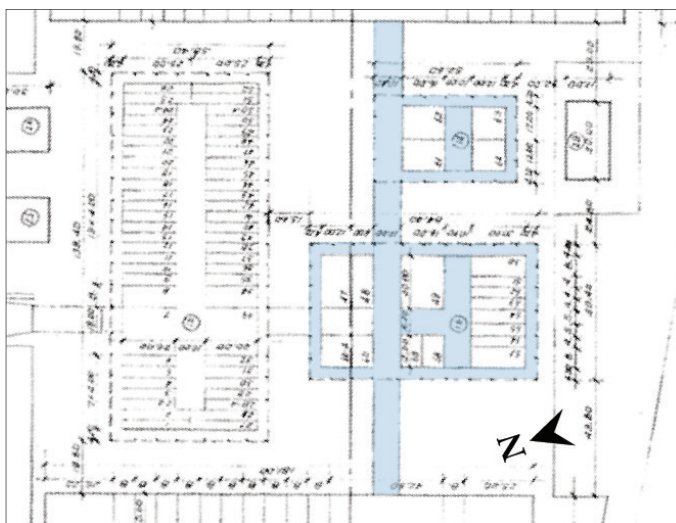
Quadra 5: ampliação da Planta de Pavimento-tipo, com lajes e marquises projetadas em destaque
